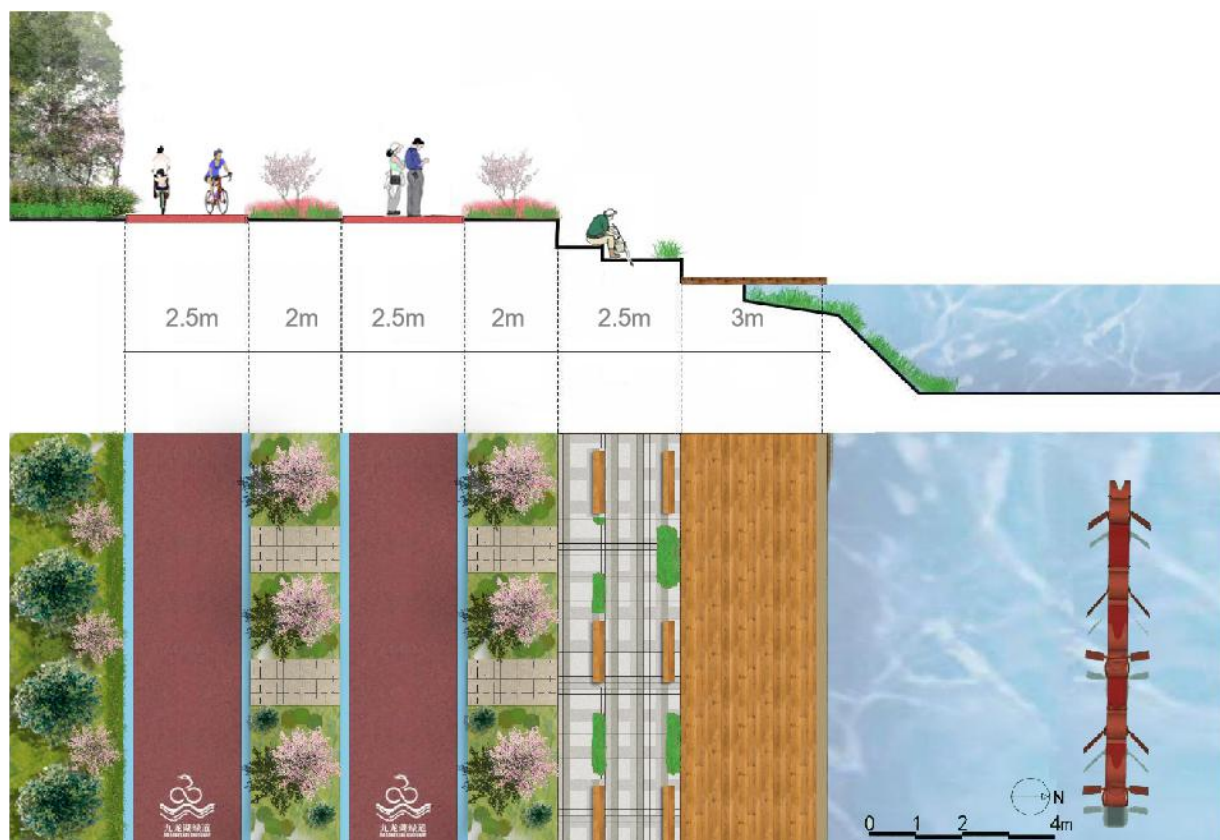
План оборудования площадки для наблюдения за гонками на лодках-драконах
